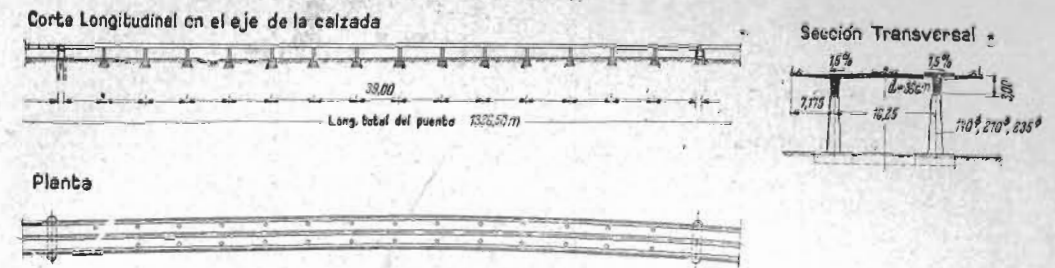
Puente Obereisesheim sobre el valle del Neckar, en Neckasulm; corte longitudinal, planta y sección transversal.
